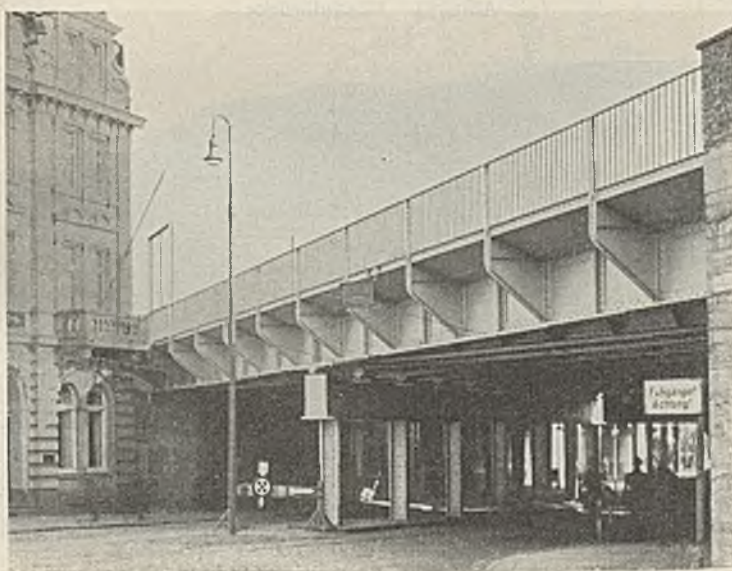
Unterführung der Mülheimer Straße in Duisburg.
